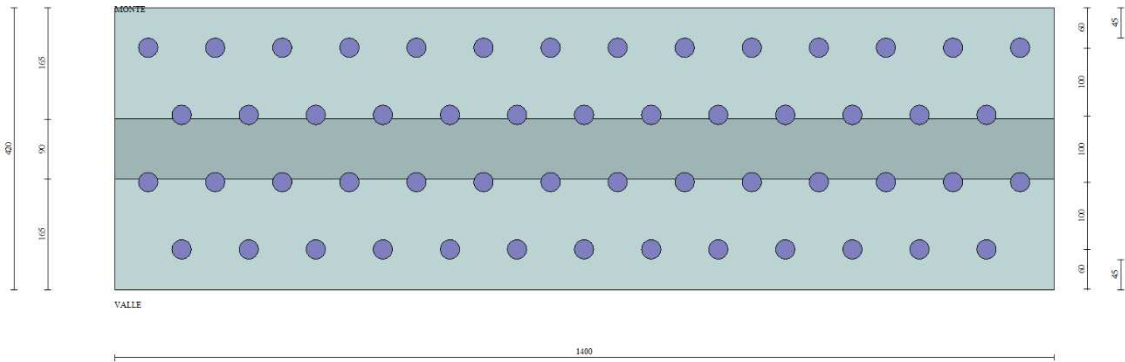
Muro Tipo C: disposizione dei micropali di fondazione.
